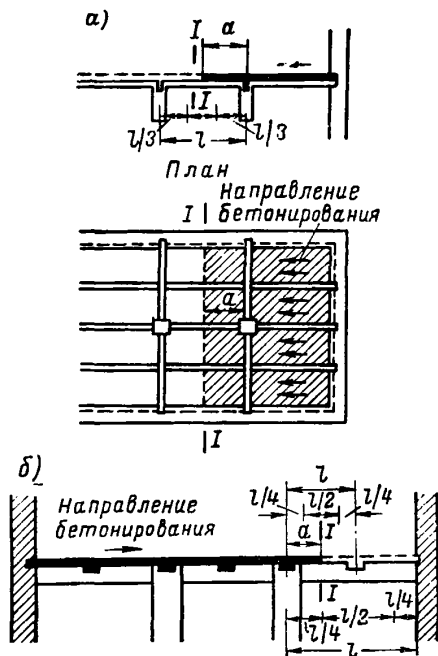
Расположение рабочих швов при бетонировании ребристых перекрытий
